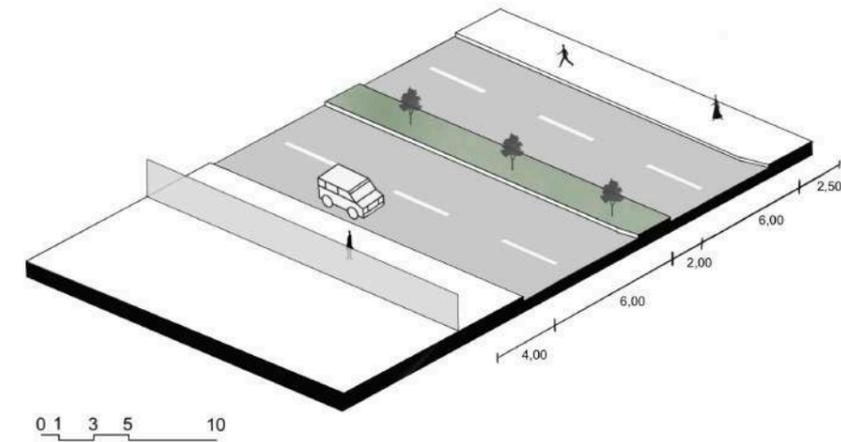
Calle Chapetones sección actual. Fuente propia.
